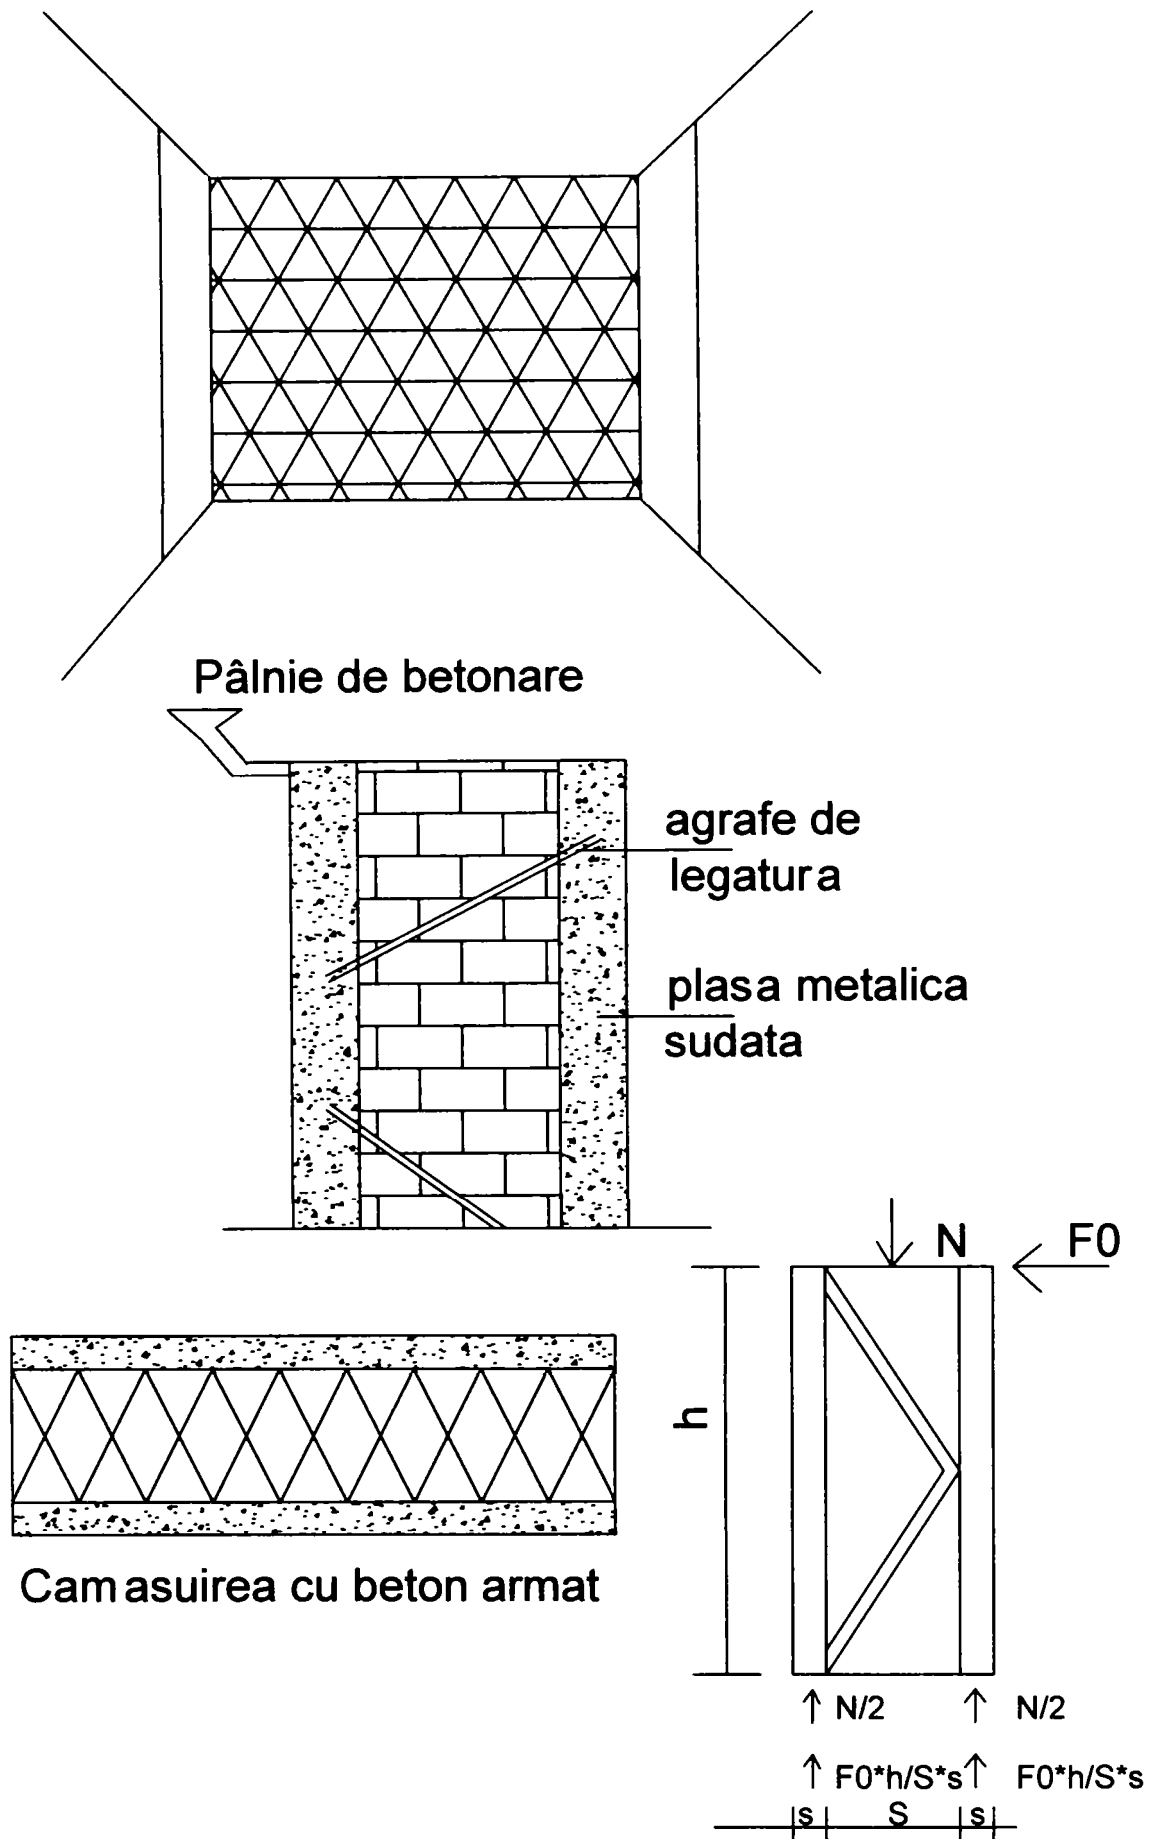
Repararea fisurilor din zidarie cu plase de armatura si beton torcretat
